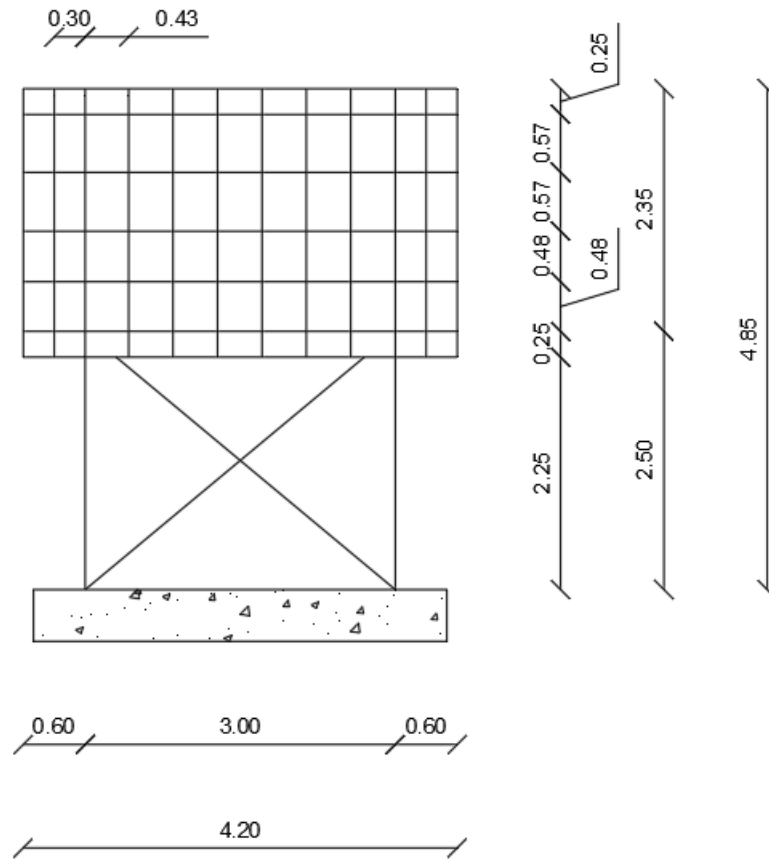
Prospetto Est dell'edificio a seguito delle modifiche.
